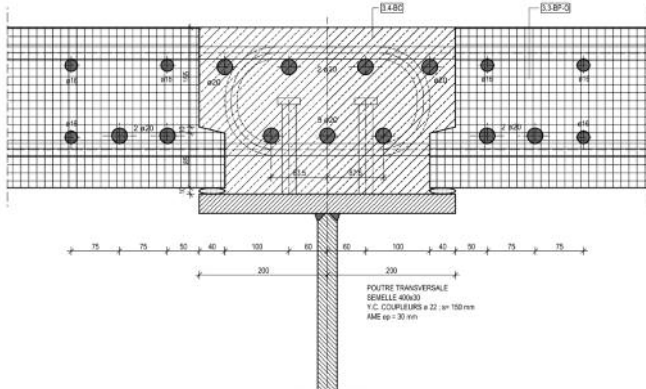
Plan-type du clavetage entre pièce de pont et dalles préfabriquées.
